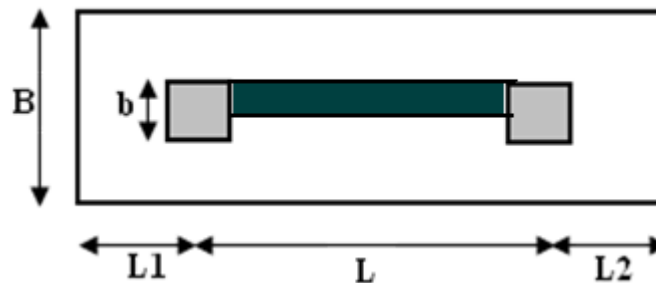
semelle filante sous 2 poteaux et 1 mur
